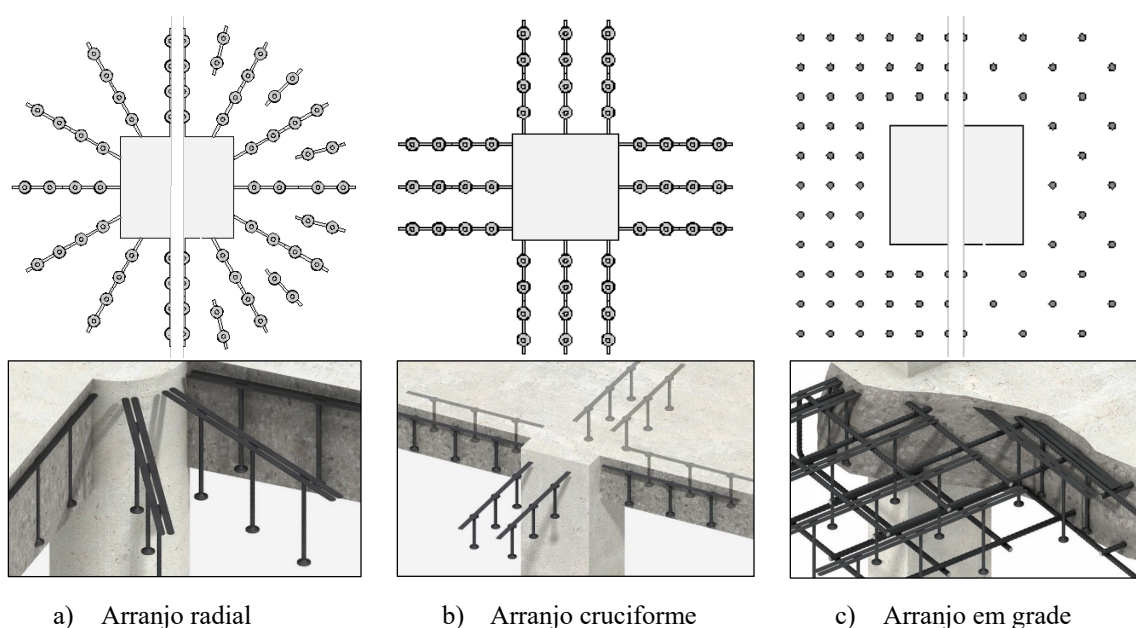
Arranjos de armadura de cisalhamento em ligações laje-pilar (adaptado de ANCON, 2014)
